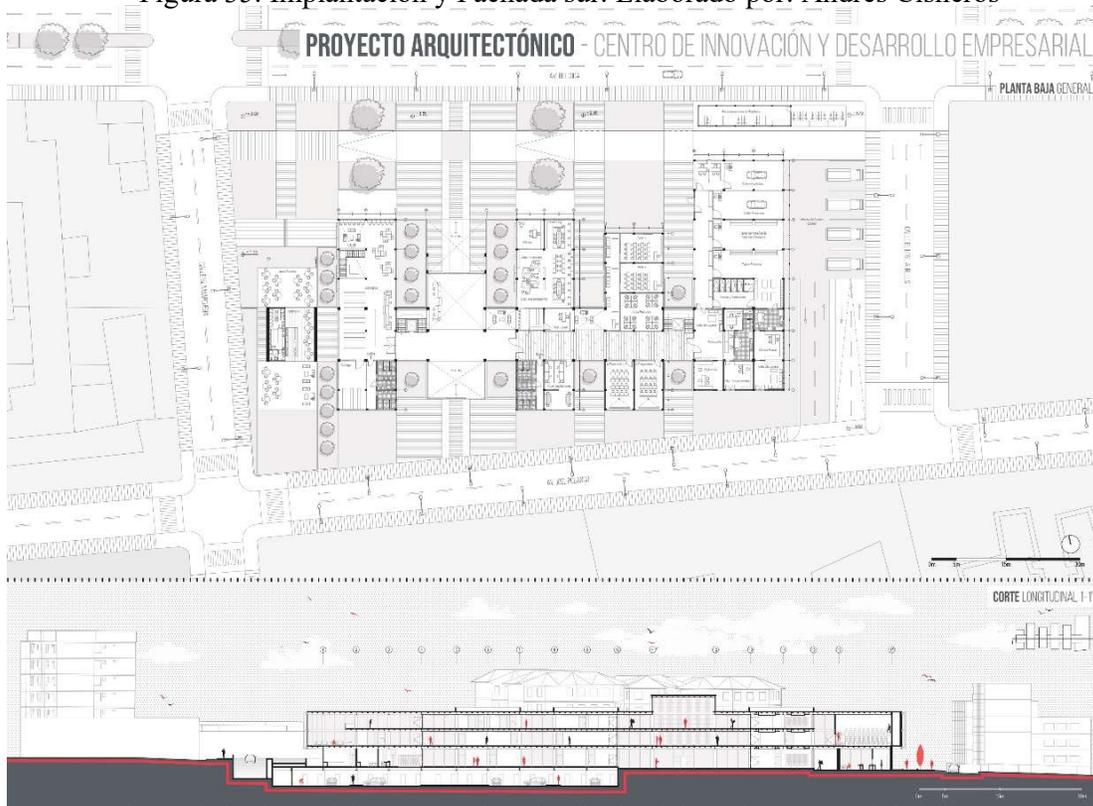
Planta baja y Corte longitudinal. Elaborado por: Andrés Cisneros
